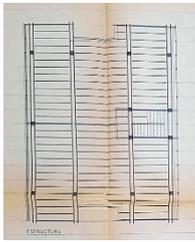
Planta Estructura B-3-3-E. 1964. Fuente: Archivo Municipal da Coruña
